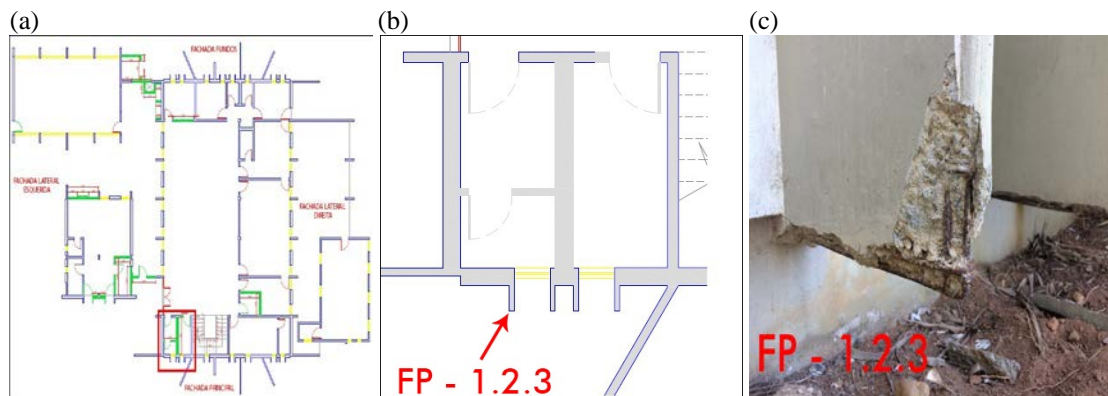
Armadura exposta na fachada principal: (a) planta baixa pavimento térreo, (b) planta baixa ampliada indicando onde a manifestação de patologia se encontra, (c) foto da manifestação de patologia
